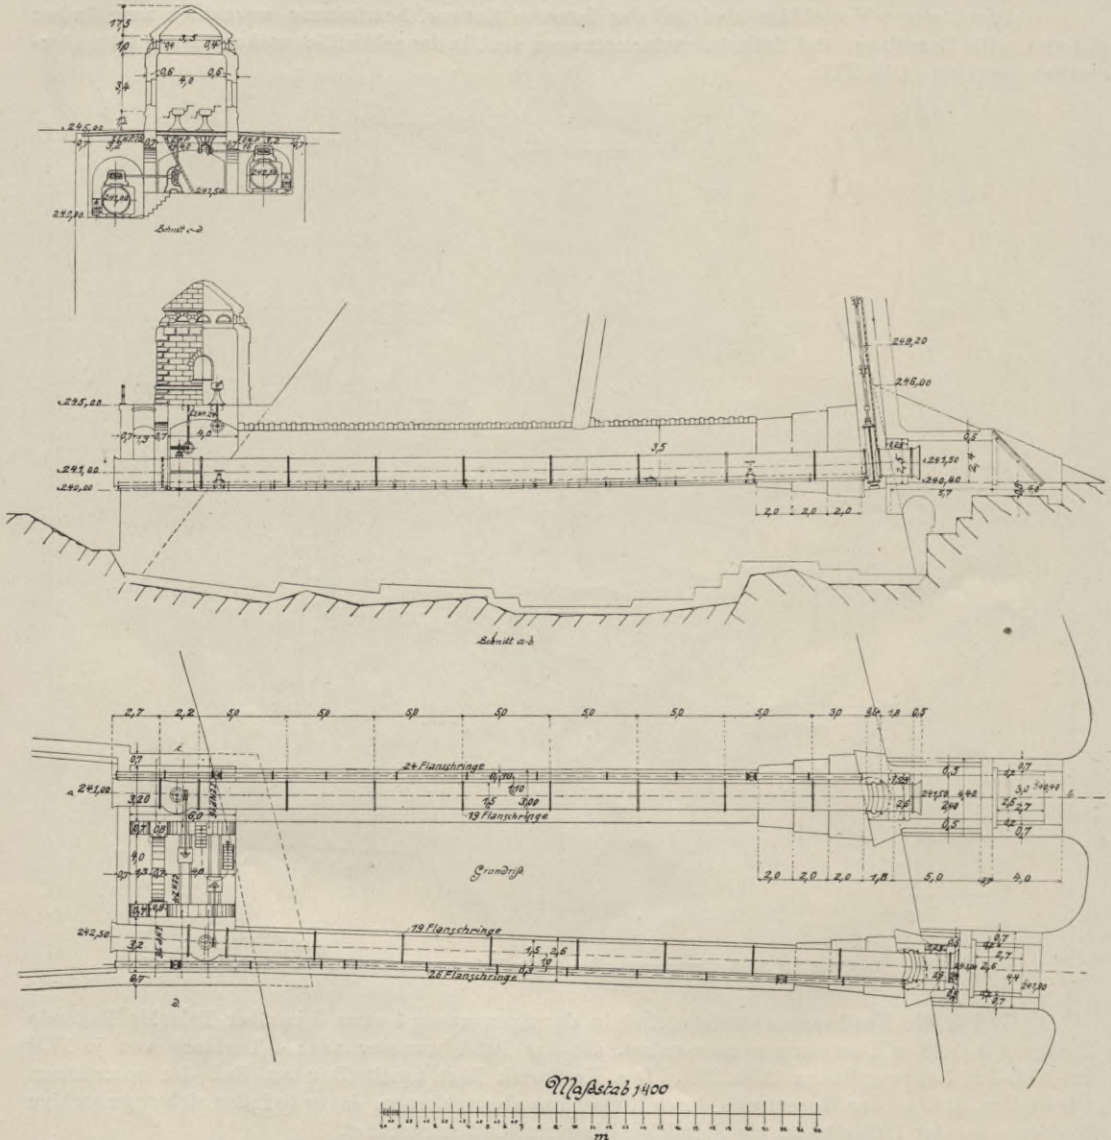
Grundablässe der Hochwasserschutzperre von Mauer.
